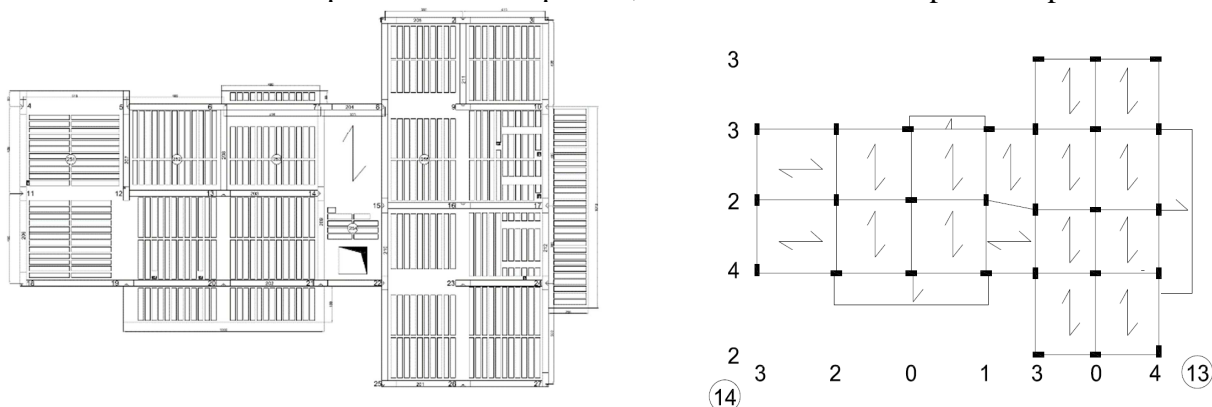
Distribuzione dei pilastri nella carpenteria tipo
